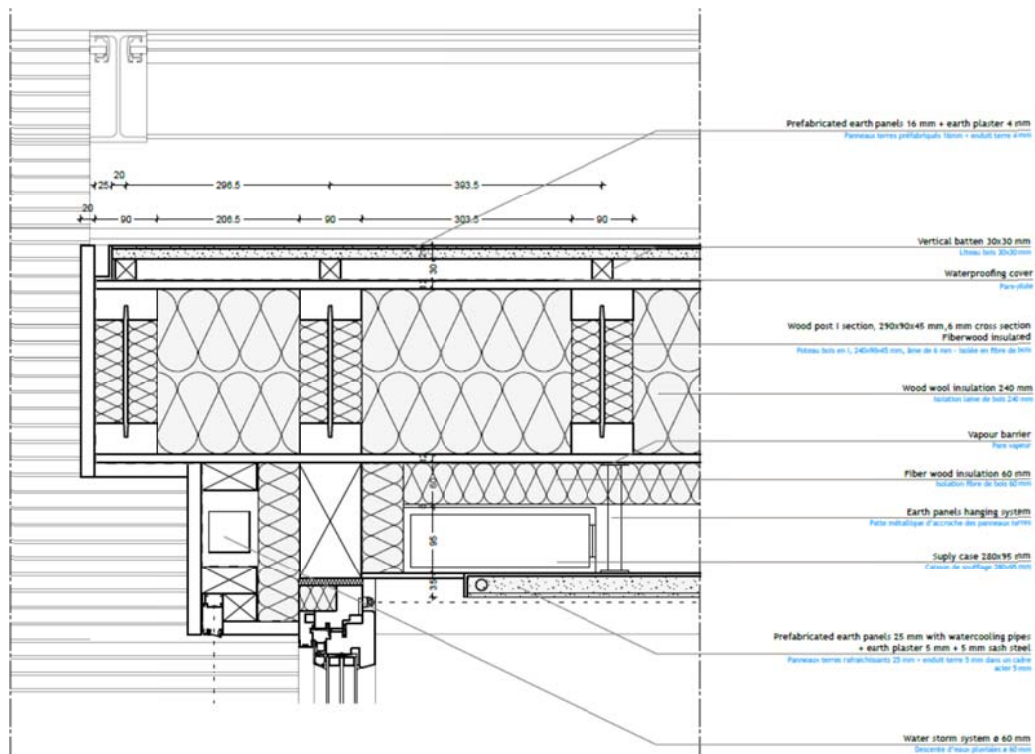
Sección en planta envolvente térmica. Fuente: GRE_CD_2010-09-22
